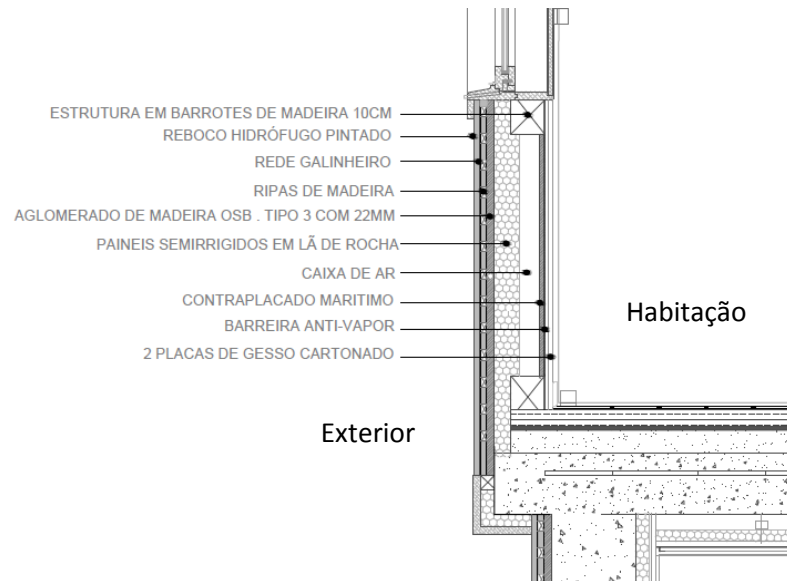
Pormenor construtivo da parede Pe13 [14]
